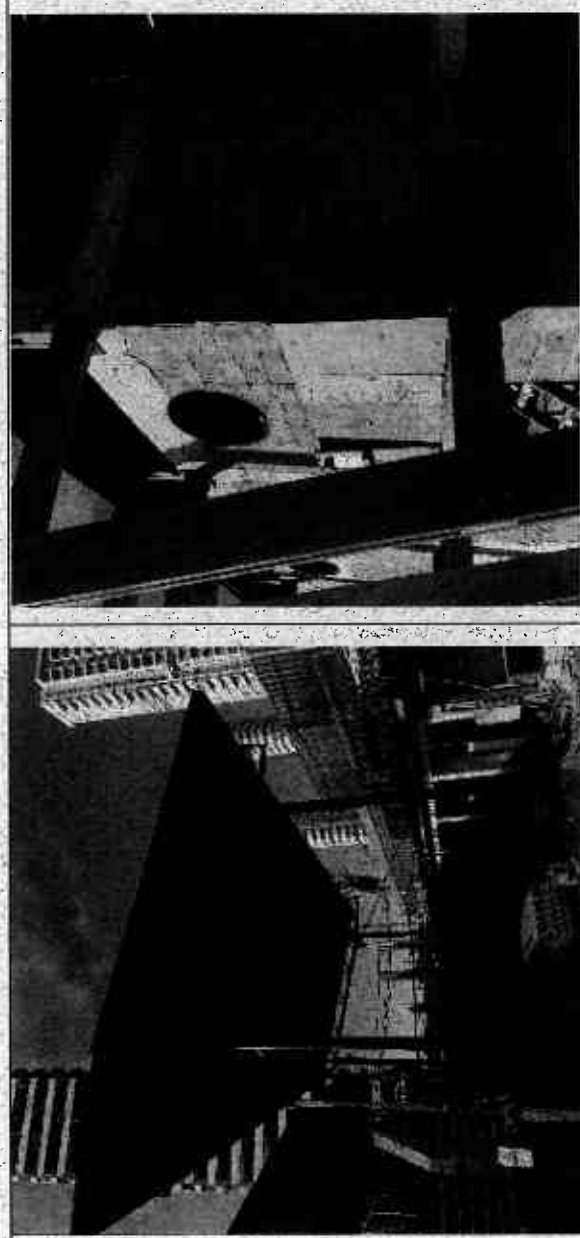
Sombradero retirado. Foto entregada por la Dirección de Obras Portuarias
